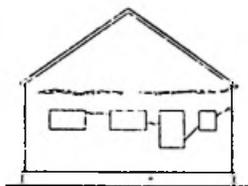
Fissuras horizontais produzidas pelo empuxo horizontal aliado ao efeito de tirante do telhado
